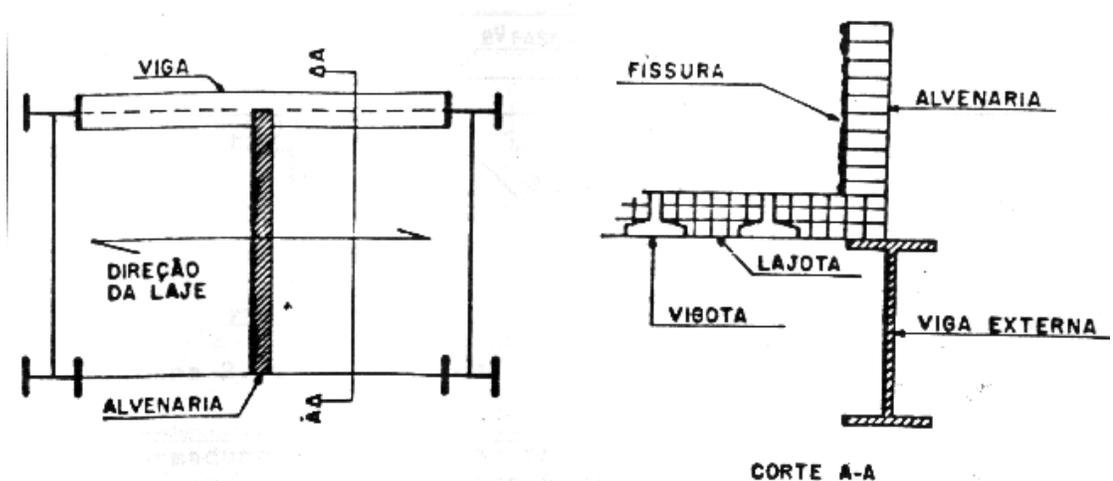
Fissura em alvenaria devido a arranjo específico entre laje pré-moldada e disposição da viga secundária e alvenaria – JÚNIOR⁴⁰
